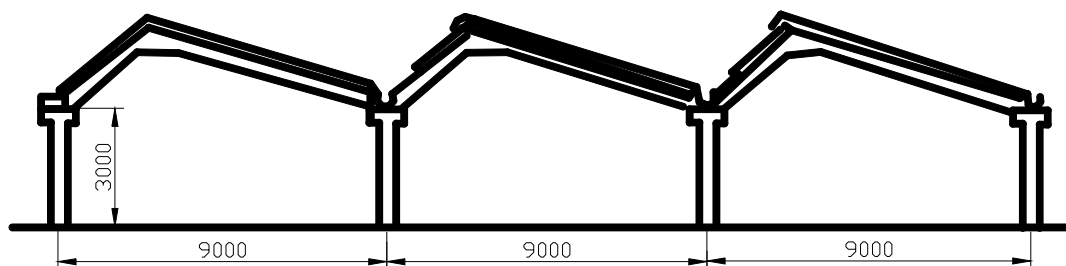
Поперечний розріз багатопрольотних будинків
